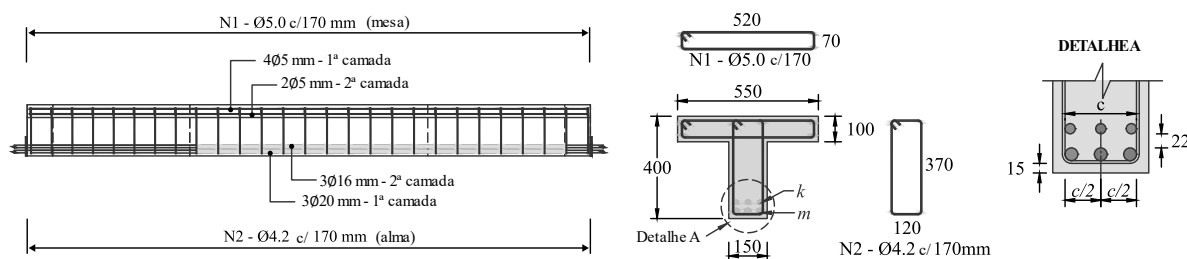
Detalhe das armaduras e reforço FRP para a viga A5-2P-U90-1. Fonte: adaptado de Salles Neto (2000).
